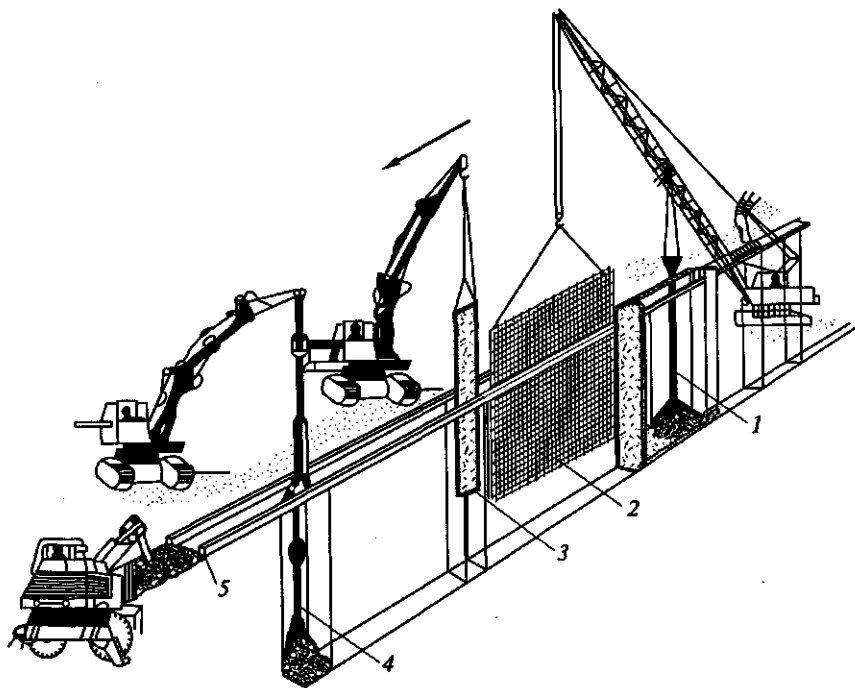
Устройство траншей монолитной «стены в грунте»:
